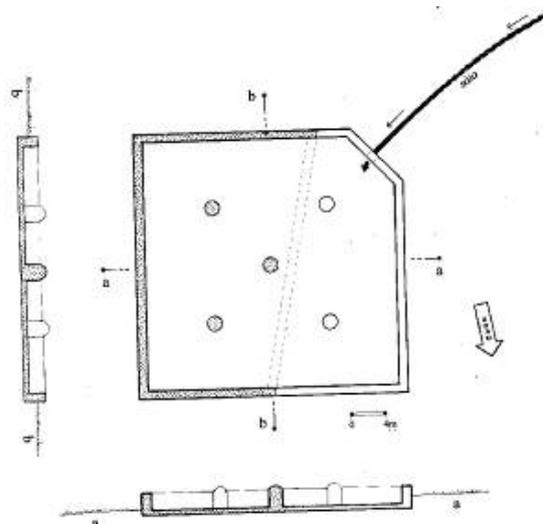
Pianta e sezione della gebbia alla Vignicella Gesuiti
